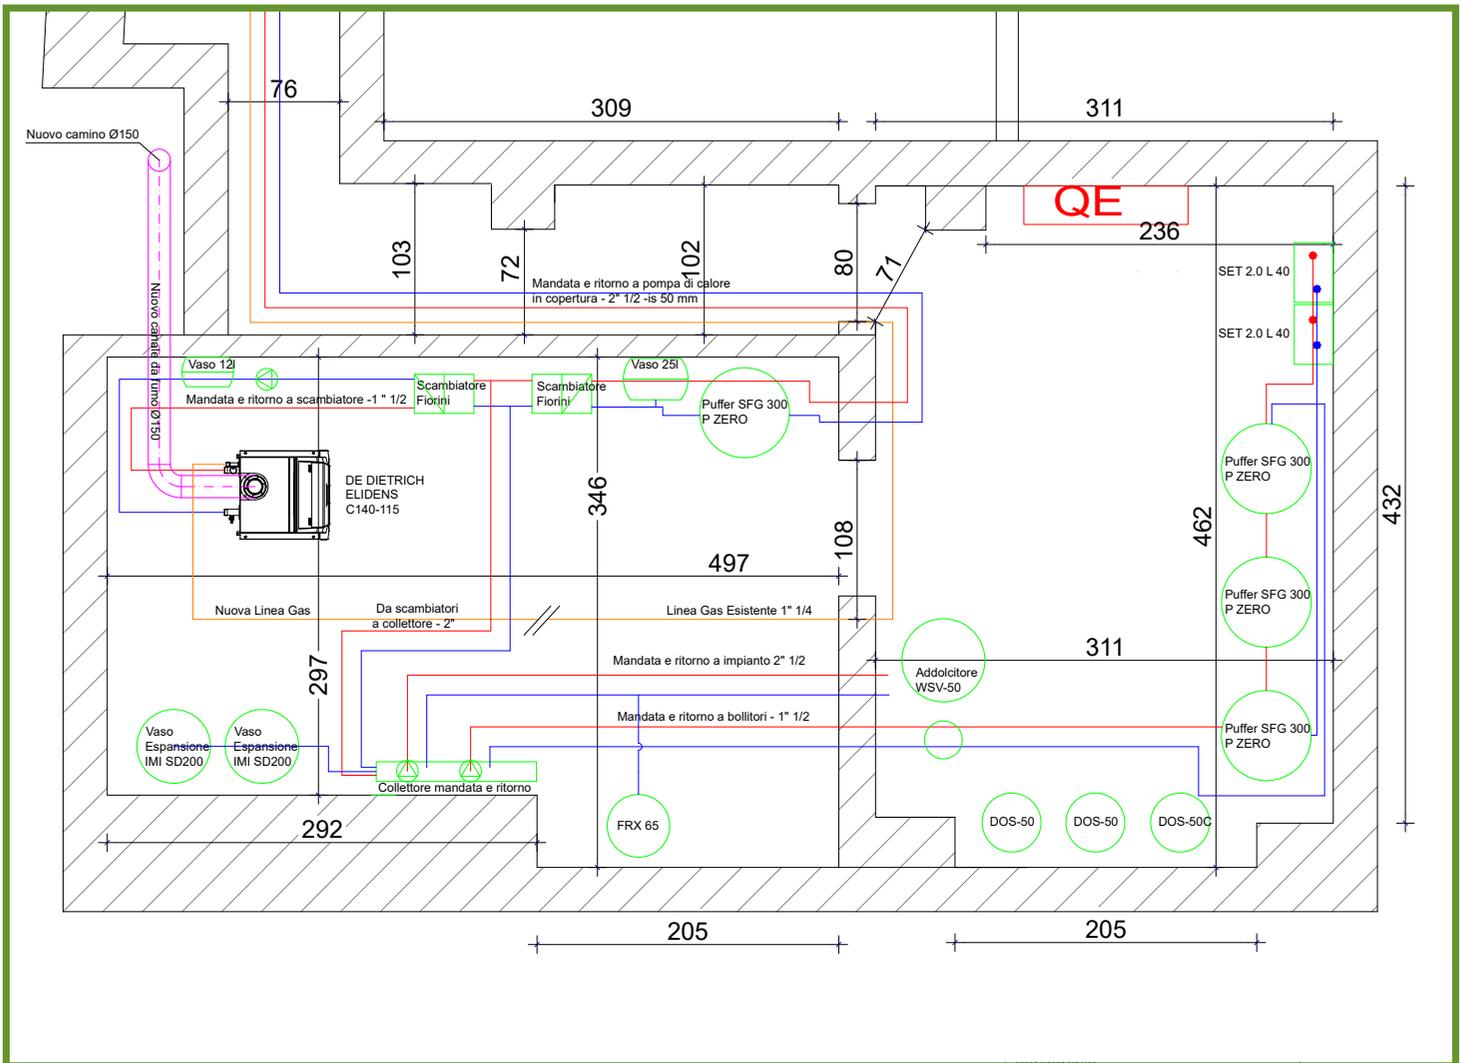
Planimetria centrale termica con posizionamento componenti principali
